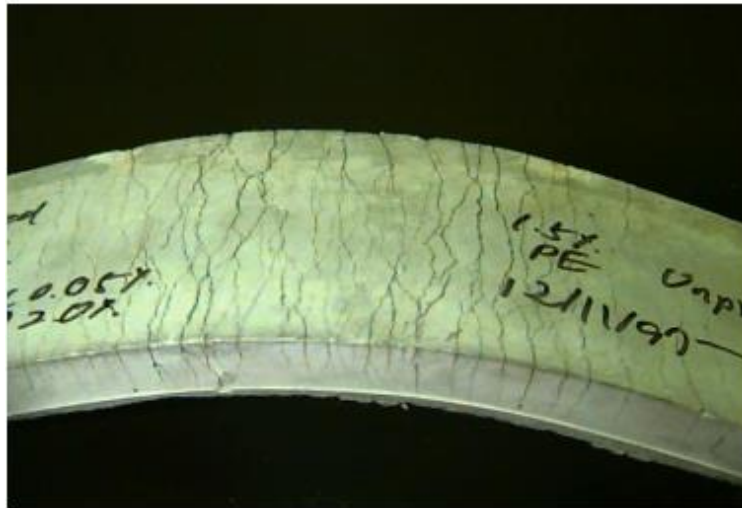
Des fissures séquentielles d'une poutre en CCHD sous charge de flexion (Li, 1998).
